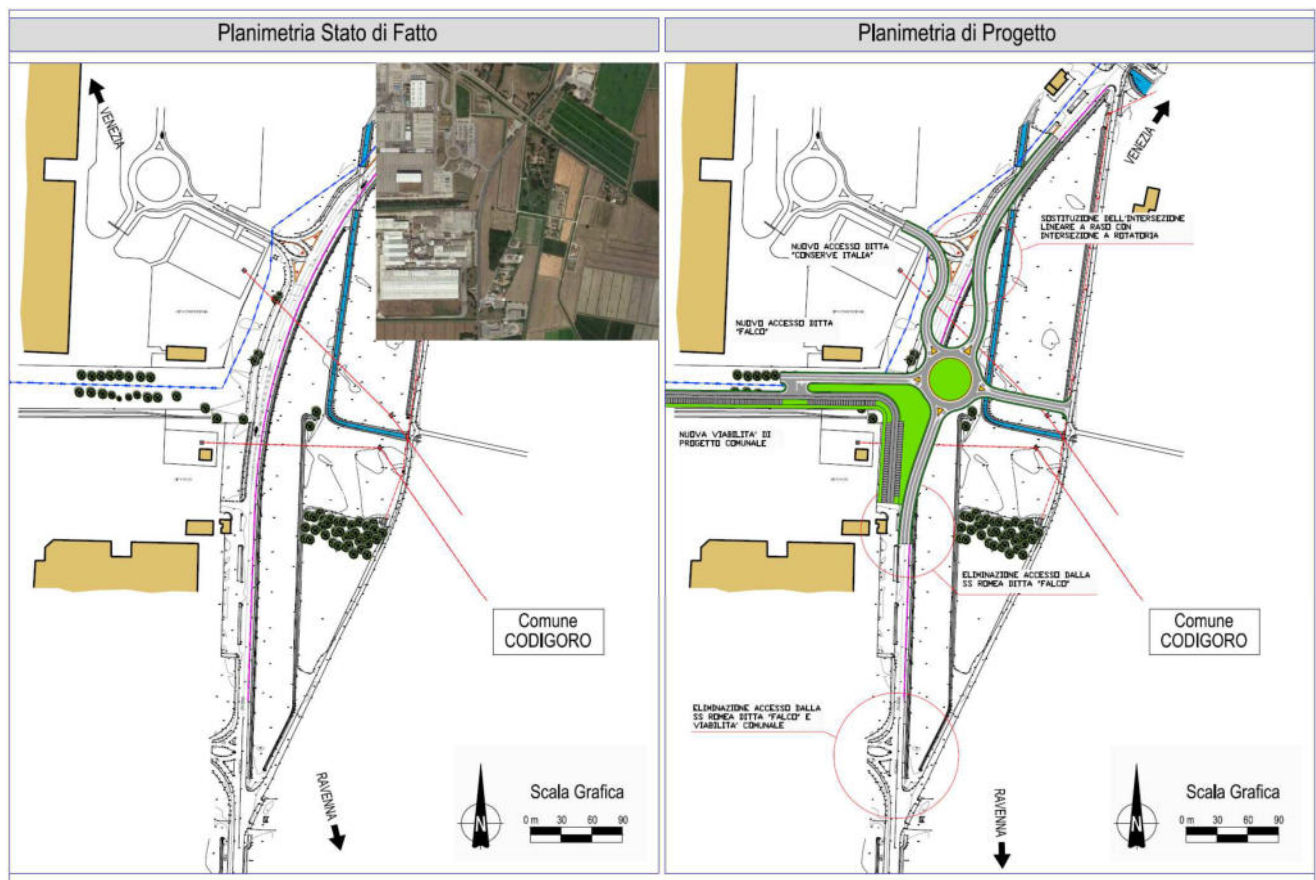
Intervento n. 18 – Planimetria Stato di Fatto e di Progetto
